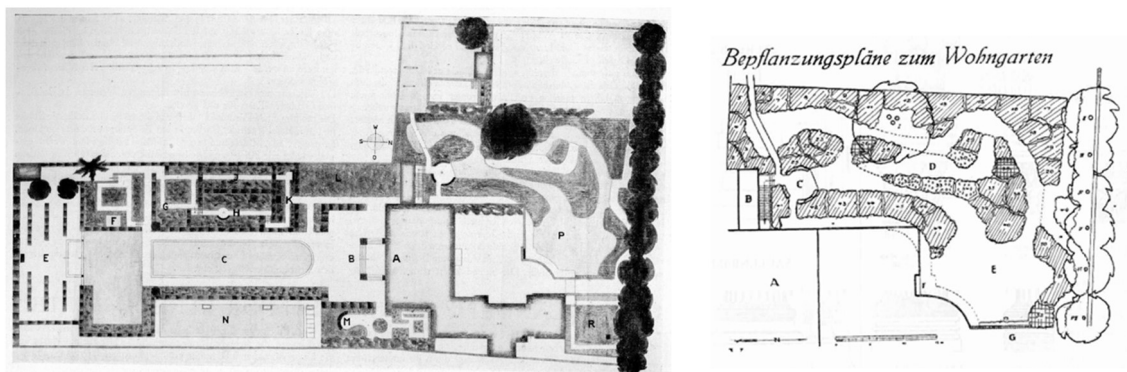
Plano Geral e Plano de Plantação para um jardim residencial, Heinz Wichmann, 1924 | fonte: Goto (2023)
